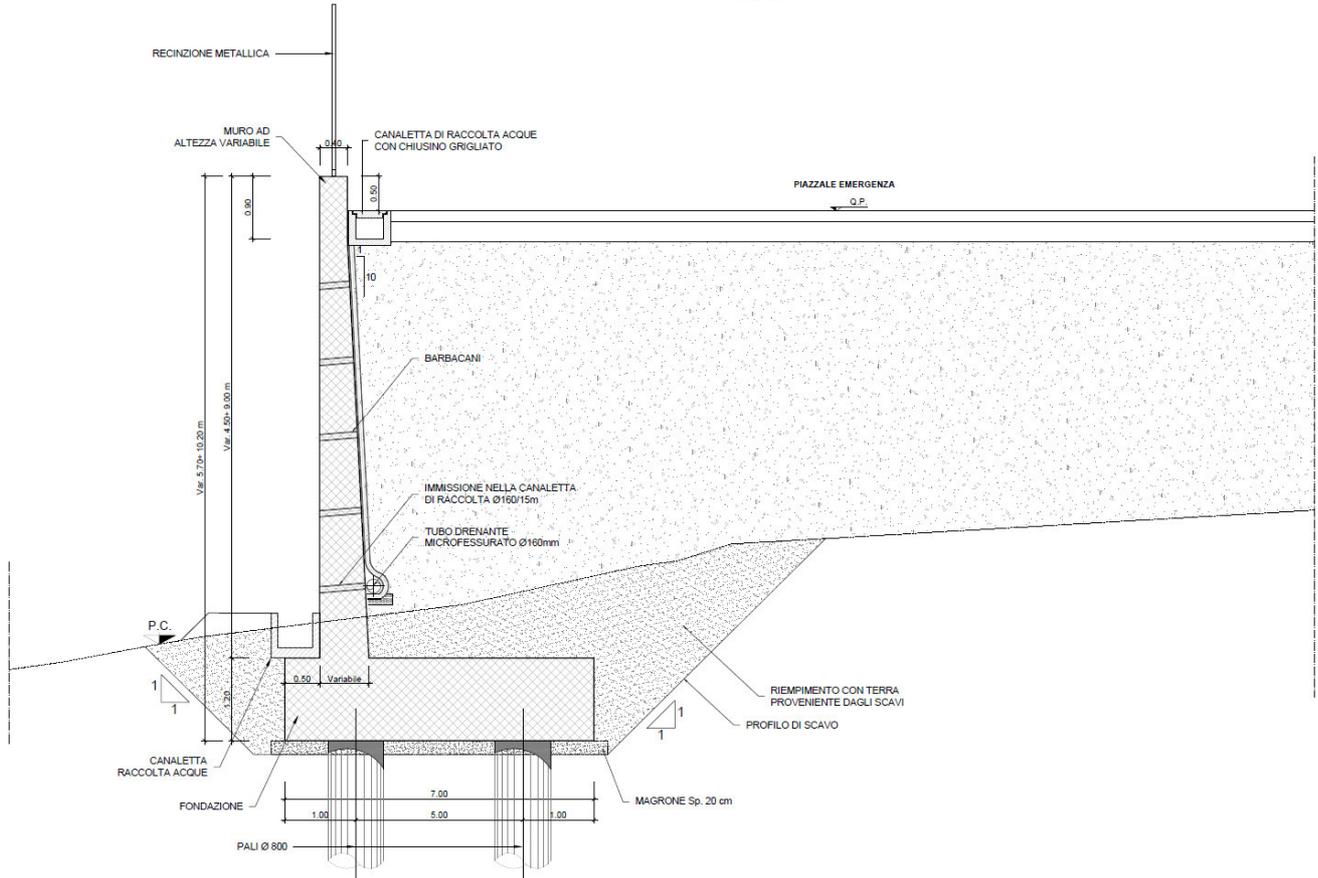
Sezione tipo piazzali con muro di sostegno (tipo ST-2)
